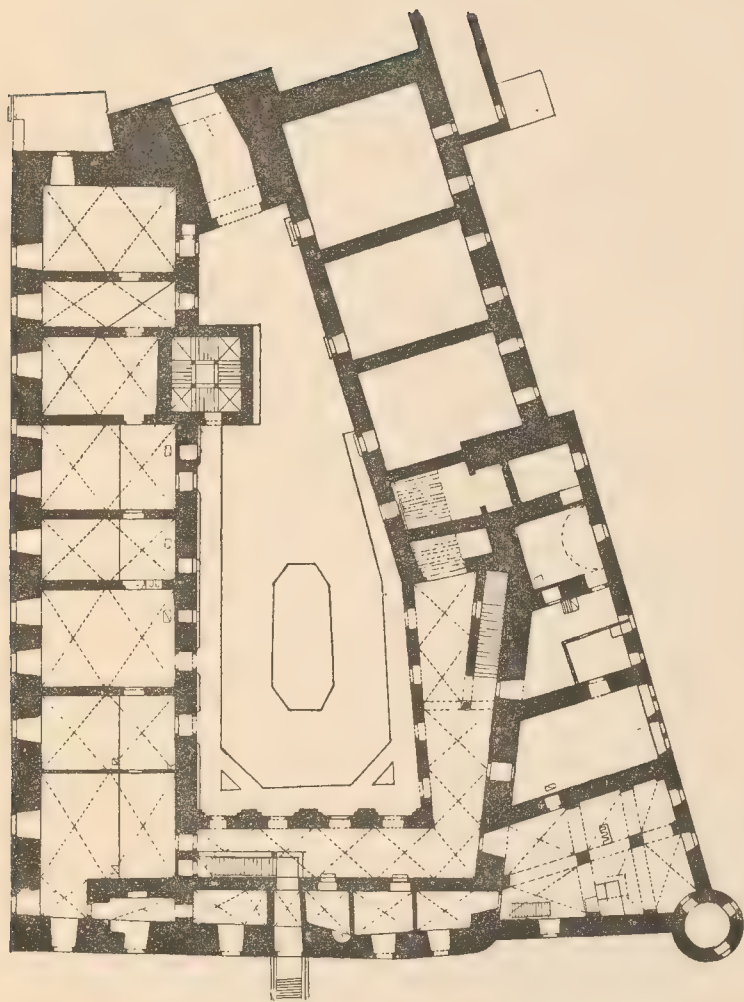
Schloß Schwarzenberg. Grundriß des Erdgeschosses.
